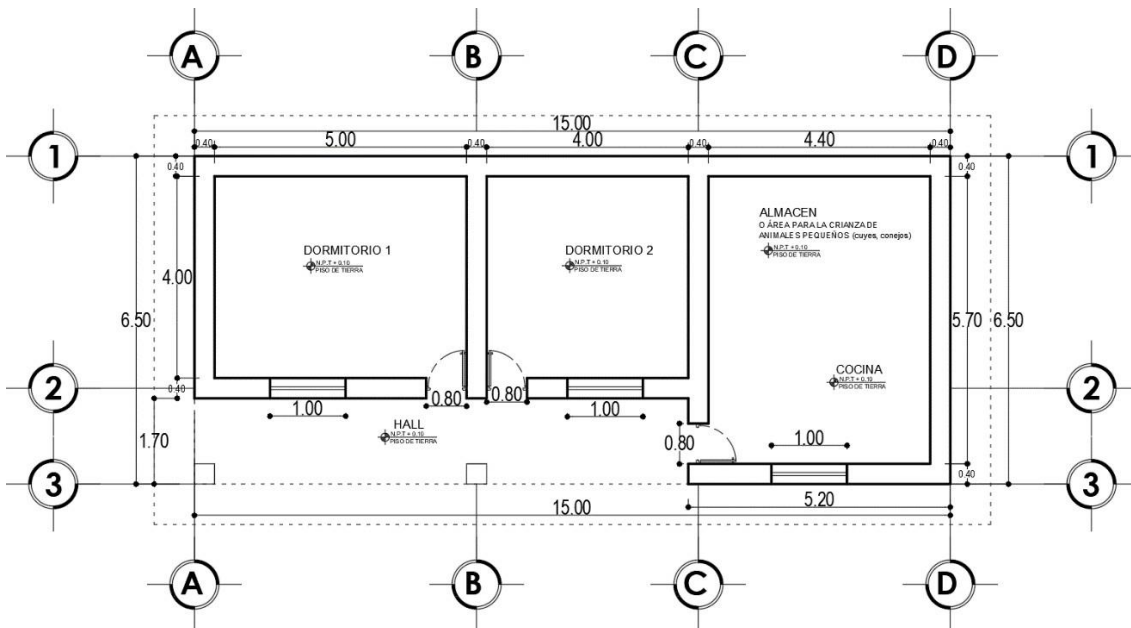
Vista en planta de vivienda típica de distrito de Utco.
